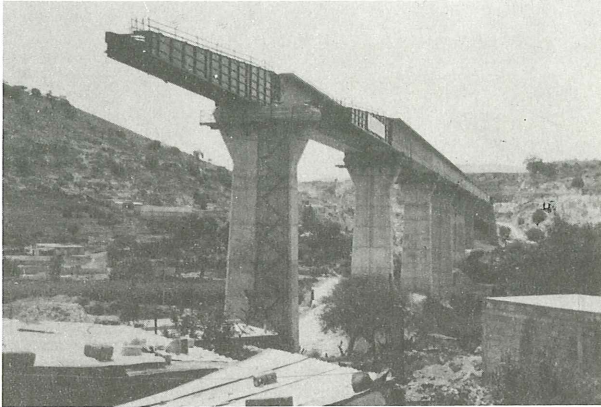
Lanzamiento de los cajones del puente de Tula.
